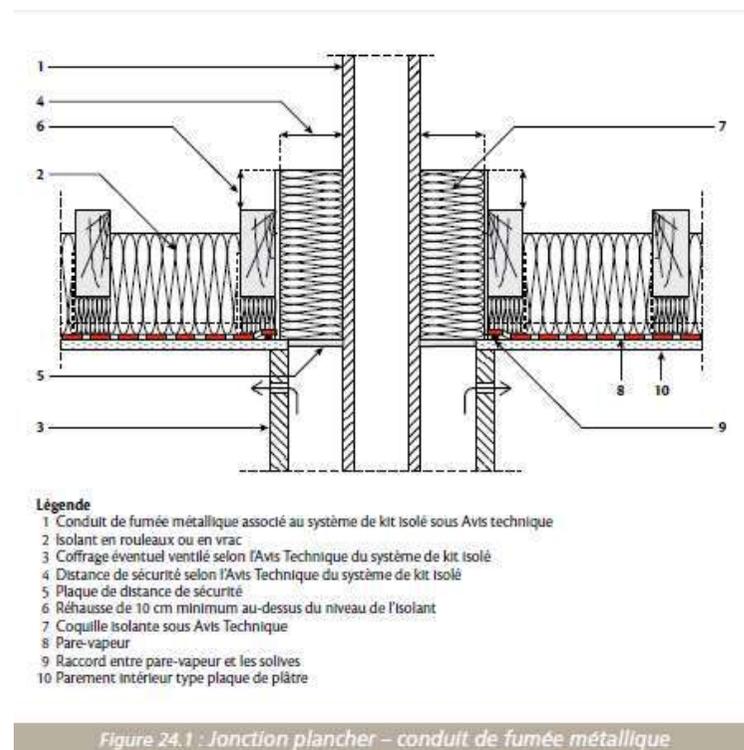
Jonction plancher – conduit de fumée métallique
